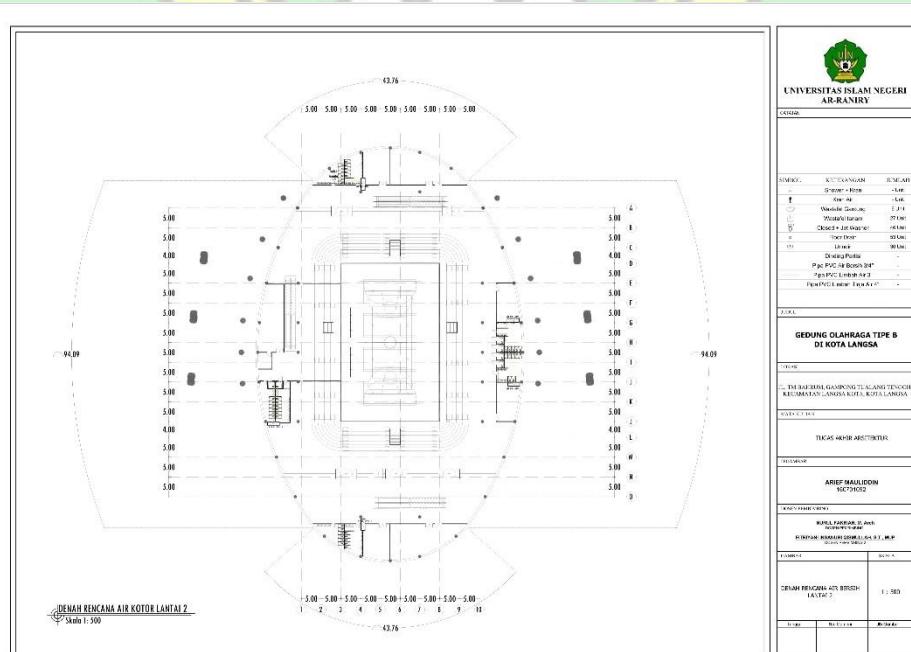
47 Denah Rencana Air Bersih Lantai 2
